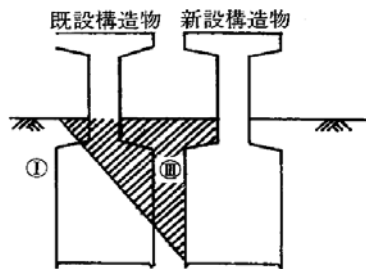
既設構造物が直接基礎またはケーソン基礎で影響Ⅲ
